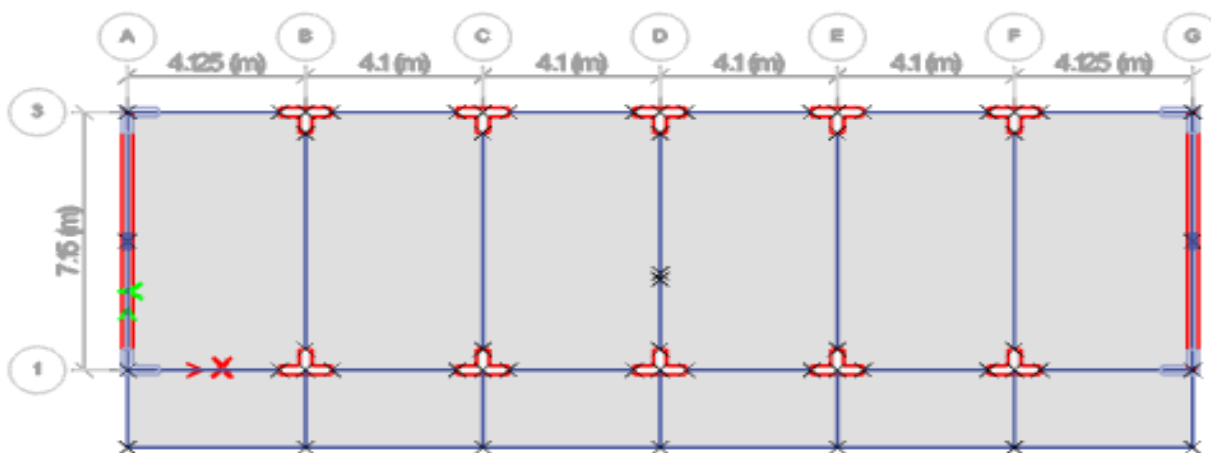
Vista modelado planta Típico del 1°, 2°, 3°
